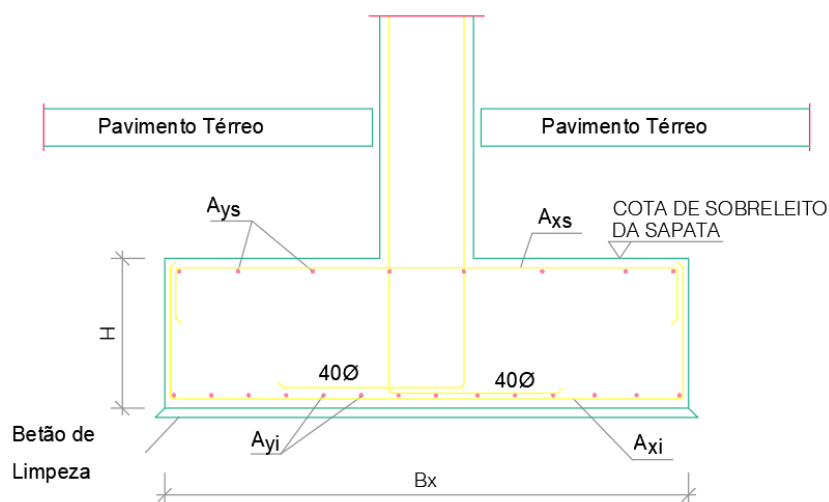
Pormenor de sapata (alçado) (Projeto de estruturas).
